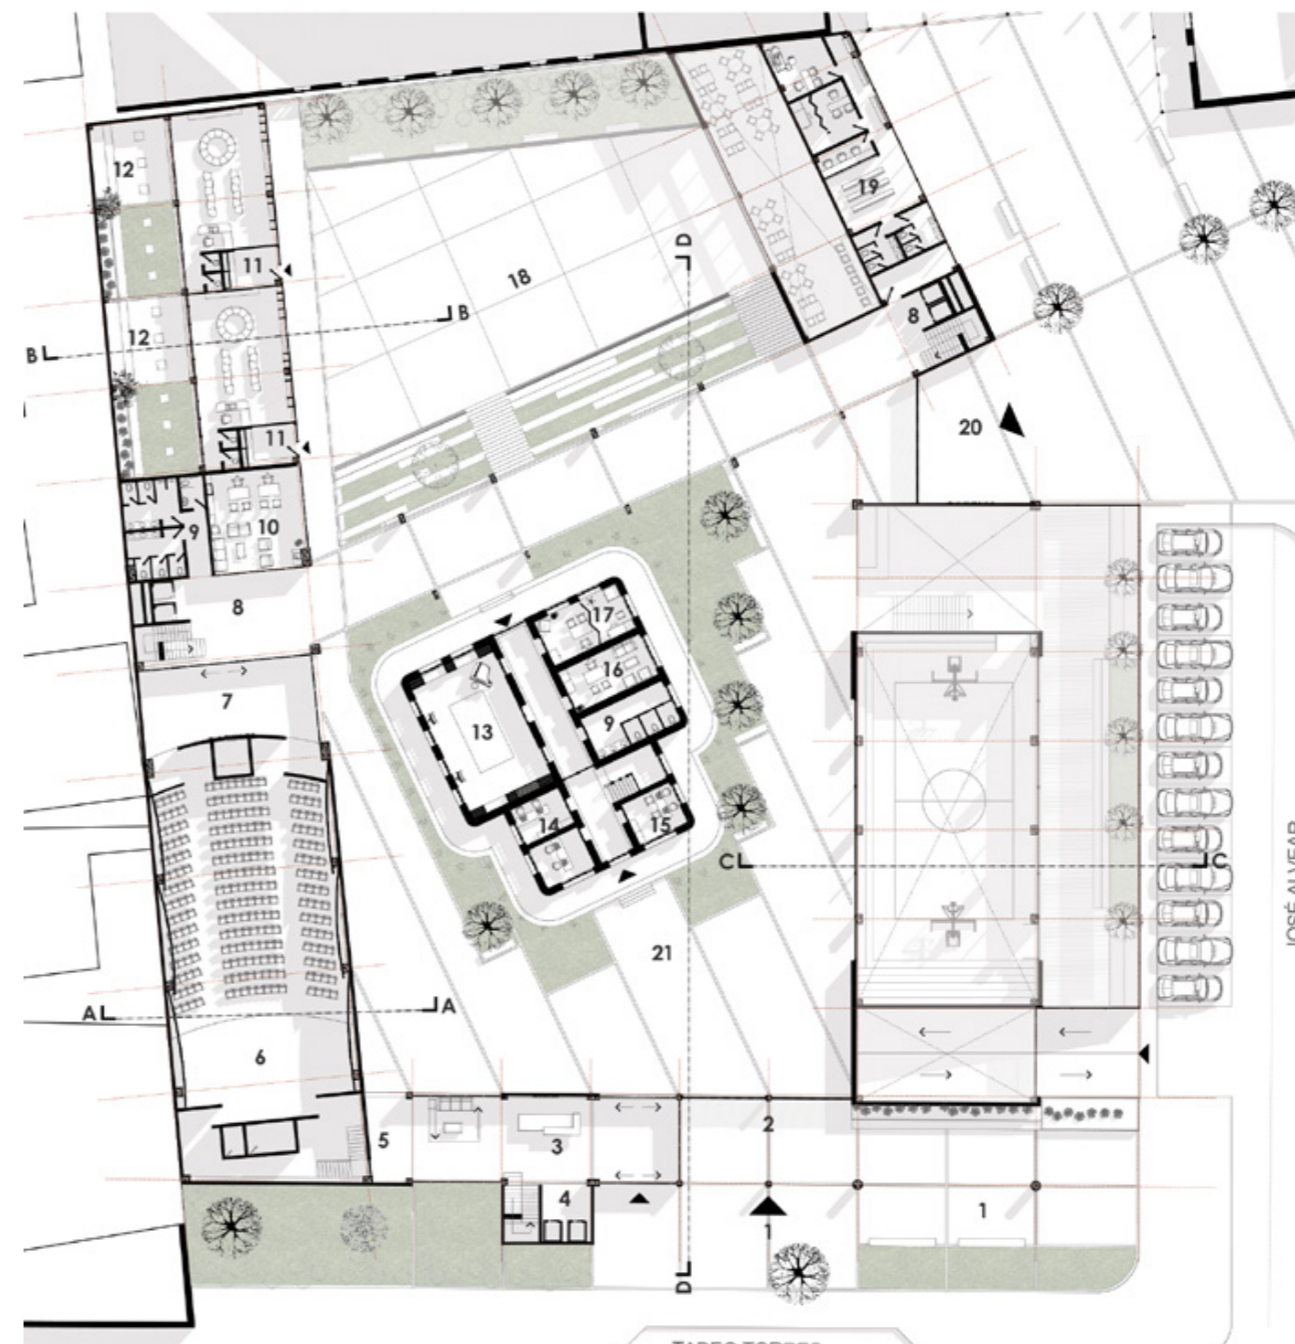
Propuesta de Planta baja | Fuente: Elaboración propia
